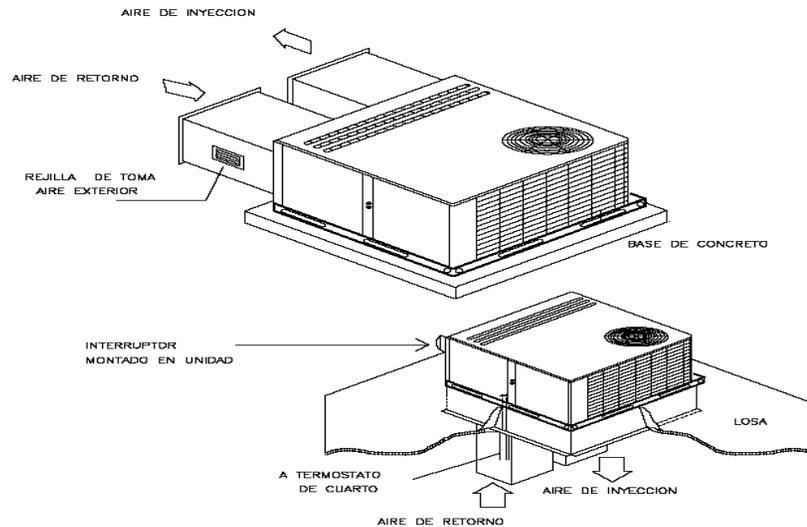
DETALLE INSTALACION UNIDAD PAQUETE EN AZOTEA
